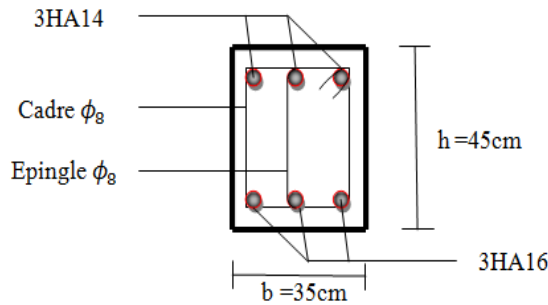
Schémas de ferrailage de la poutre brisée
